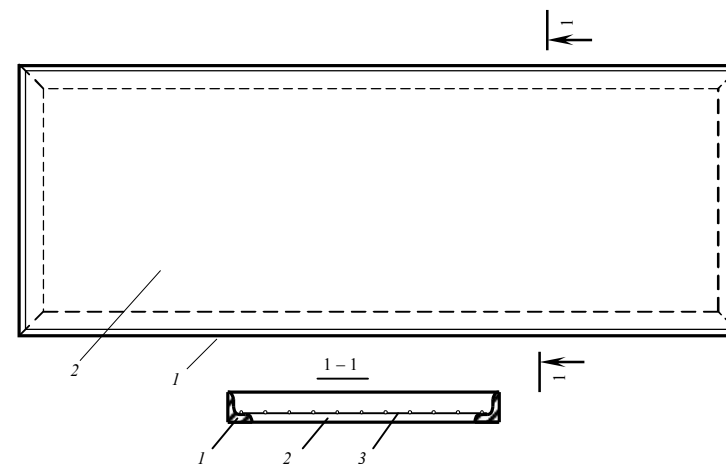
Схема залізобетонної плити зі сталевим обрамленням
